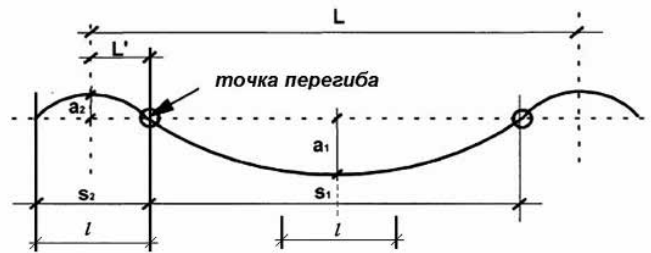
Профиль раскладки напрягаемых элементов по высоте сечения в пролёте и на опорах
